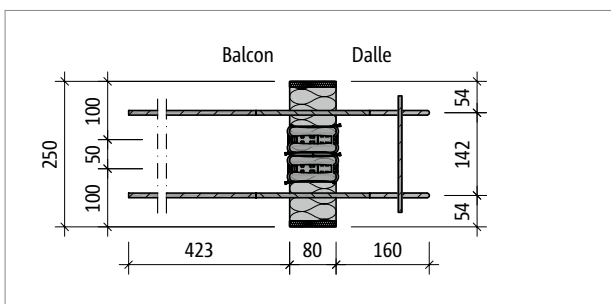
Schöck Isokorb® T type Q-E-W-V4-L250 : plan de base du produit
